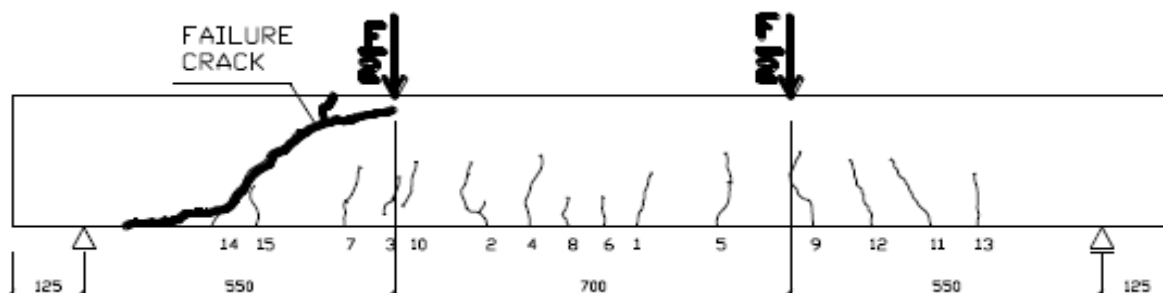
Fissuração do ensaio E5, apresentada por Slowik (2014). Fonte: (SLOWIK, 2014)
